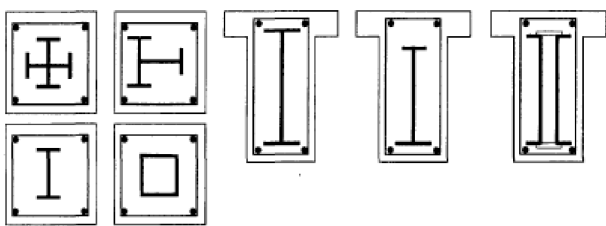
不同形式配钢的型钢混凝土柱、梁构件截面图
